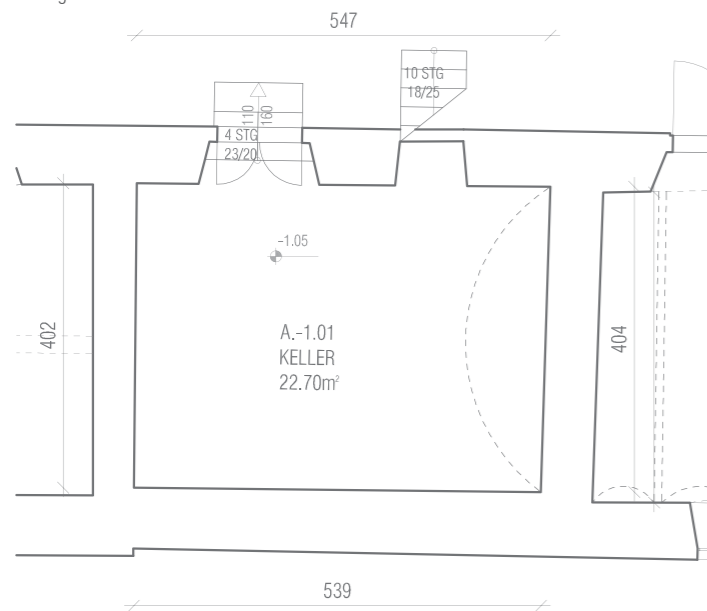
Grundriss Raum A.-1.01_1:100
